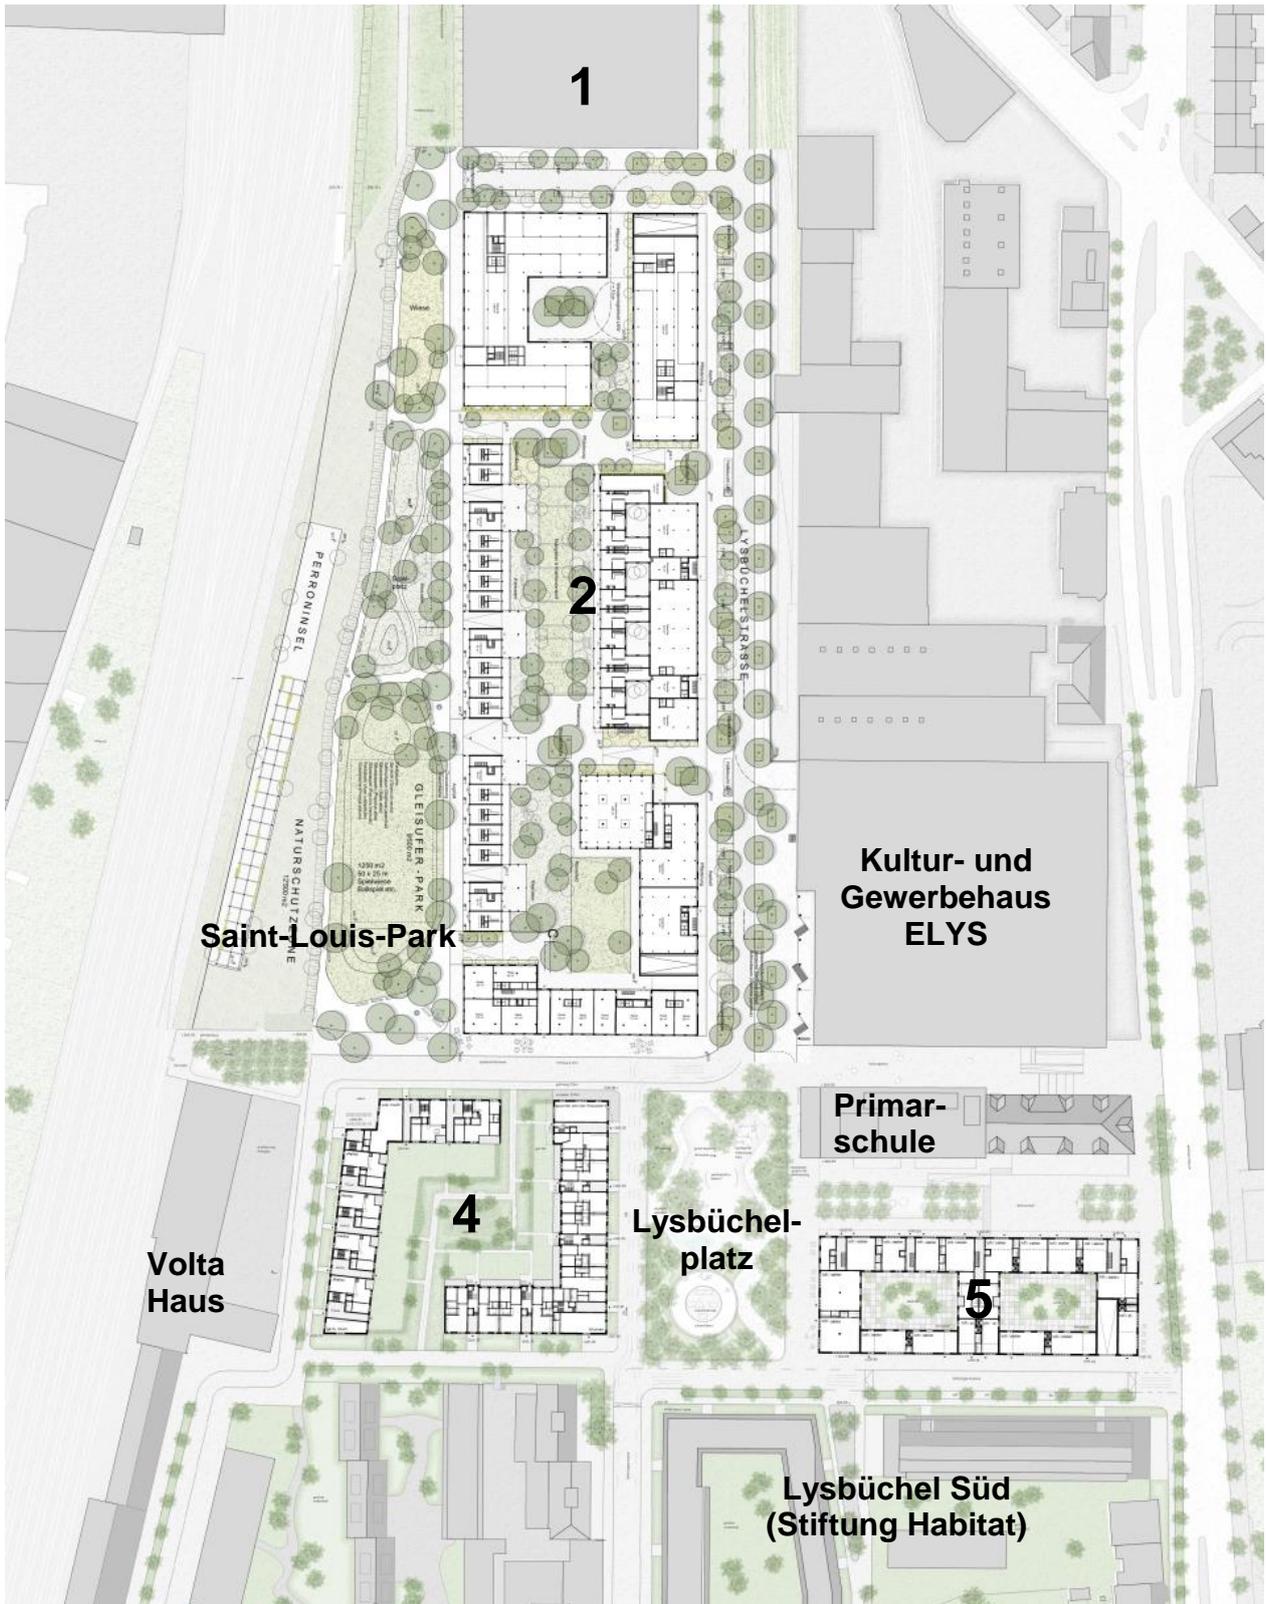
Synthesekonzept städtebauliche Studie (2019) mit Grundrissbeispielen (Erdgeschoss)
